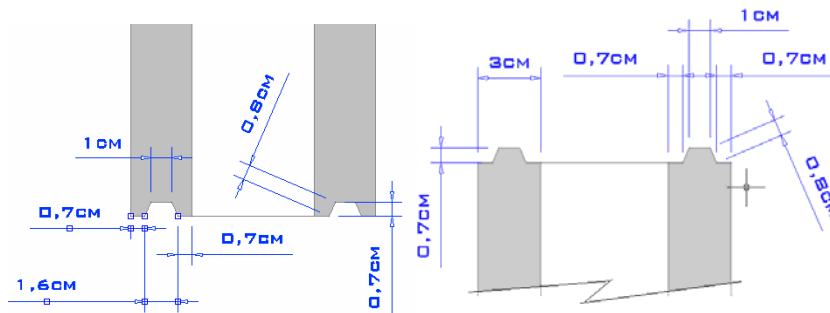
DETALLE ENCAJES BORDE DE FRICCIÓN.
